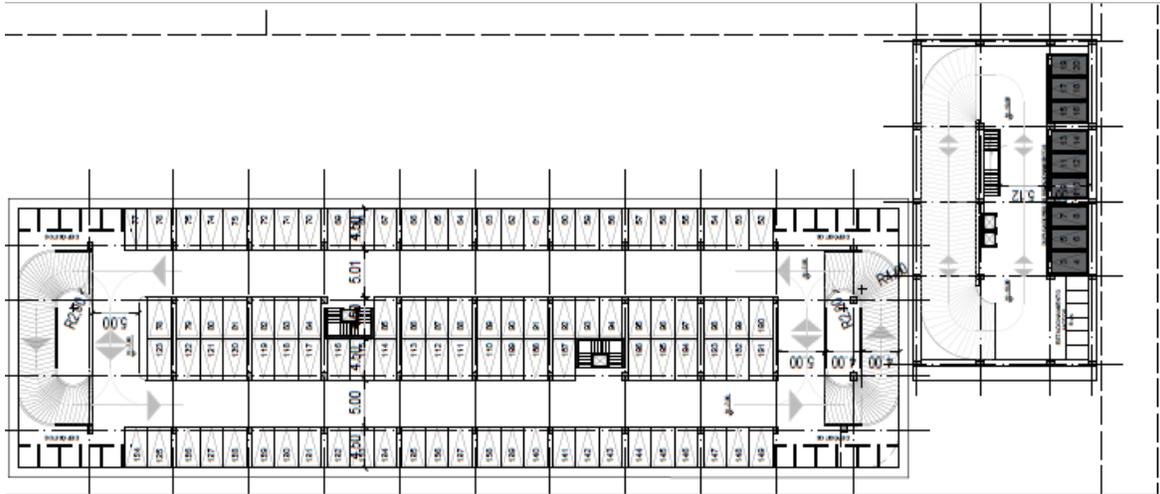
PF13. Planta Estacionamientos – Sótano 2
